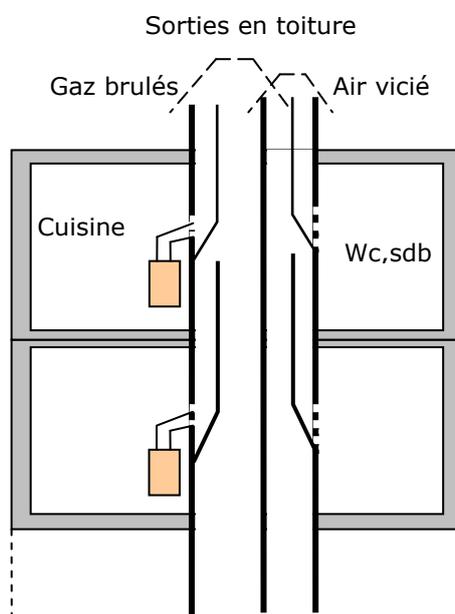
Schéma de principe d'une installation avec conduits shunt
